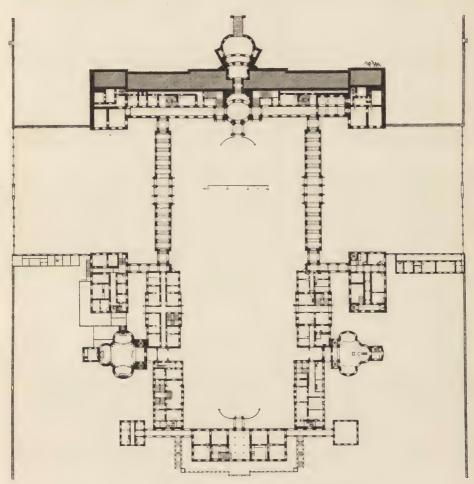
Schloss Ludwigsburg. Grundriss des Erdgeschosses.
